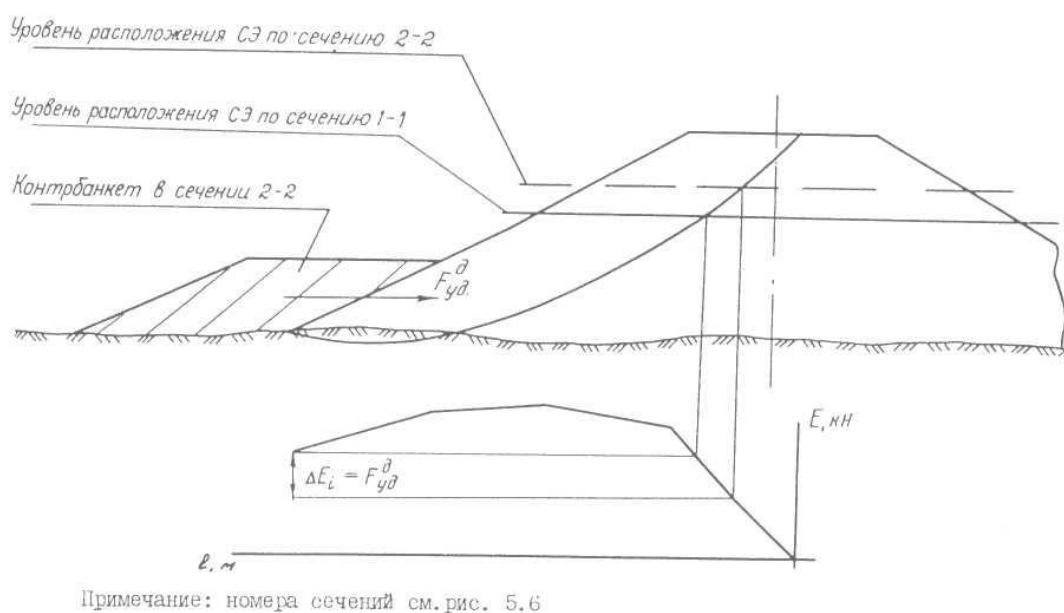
Схема до визначення висоти установки СЕ по різних перетинах насипу
